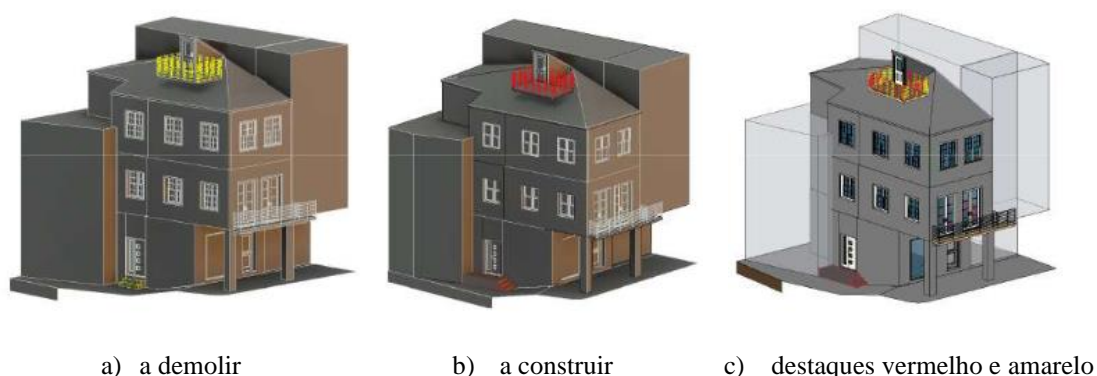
Vista 3D das fachadas (Silva, 2021)
